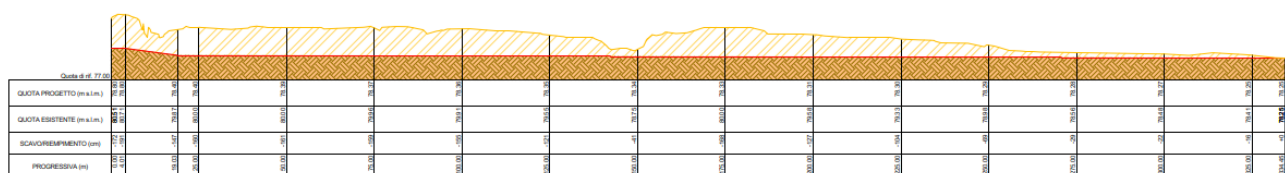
Profilo longitudinale di progetto del canale. Estratto dalla tavola PF.0.0.8.PRG.GE.S.Z.0.0.2.A.
